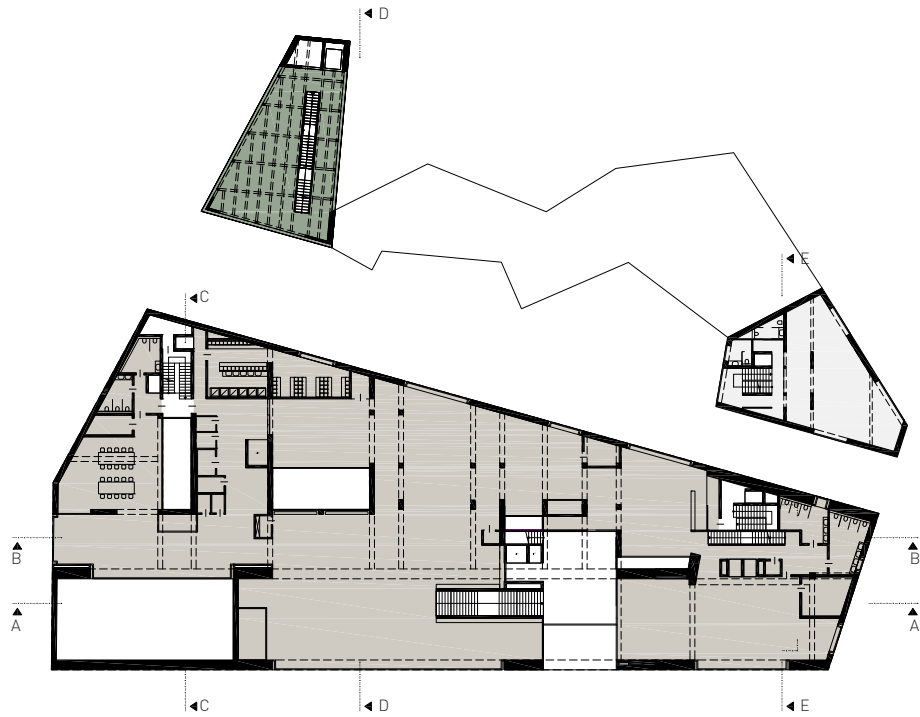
Grundriss Funktionen 1.OG +6,70m
